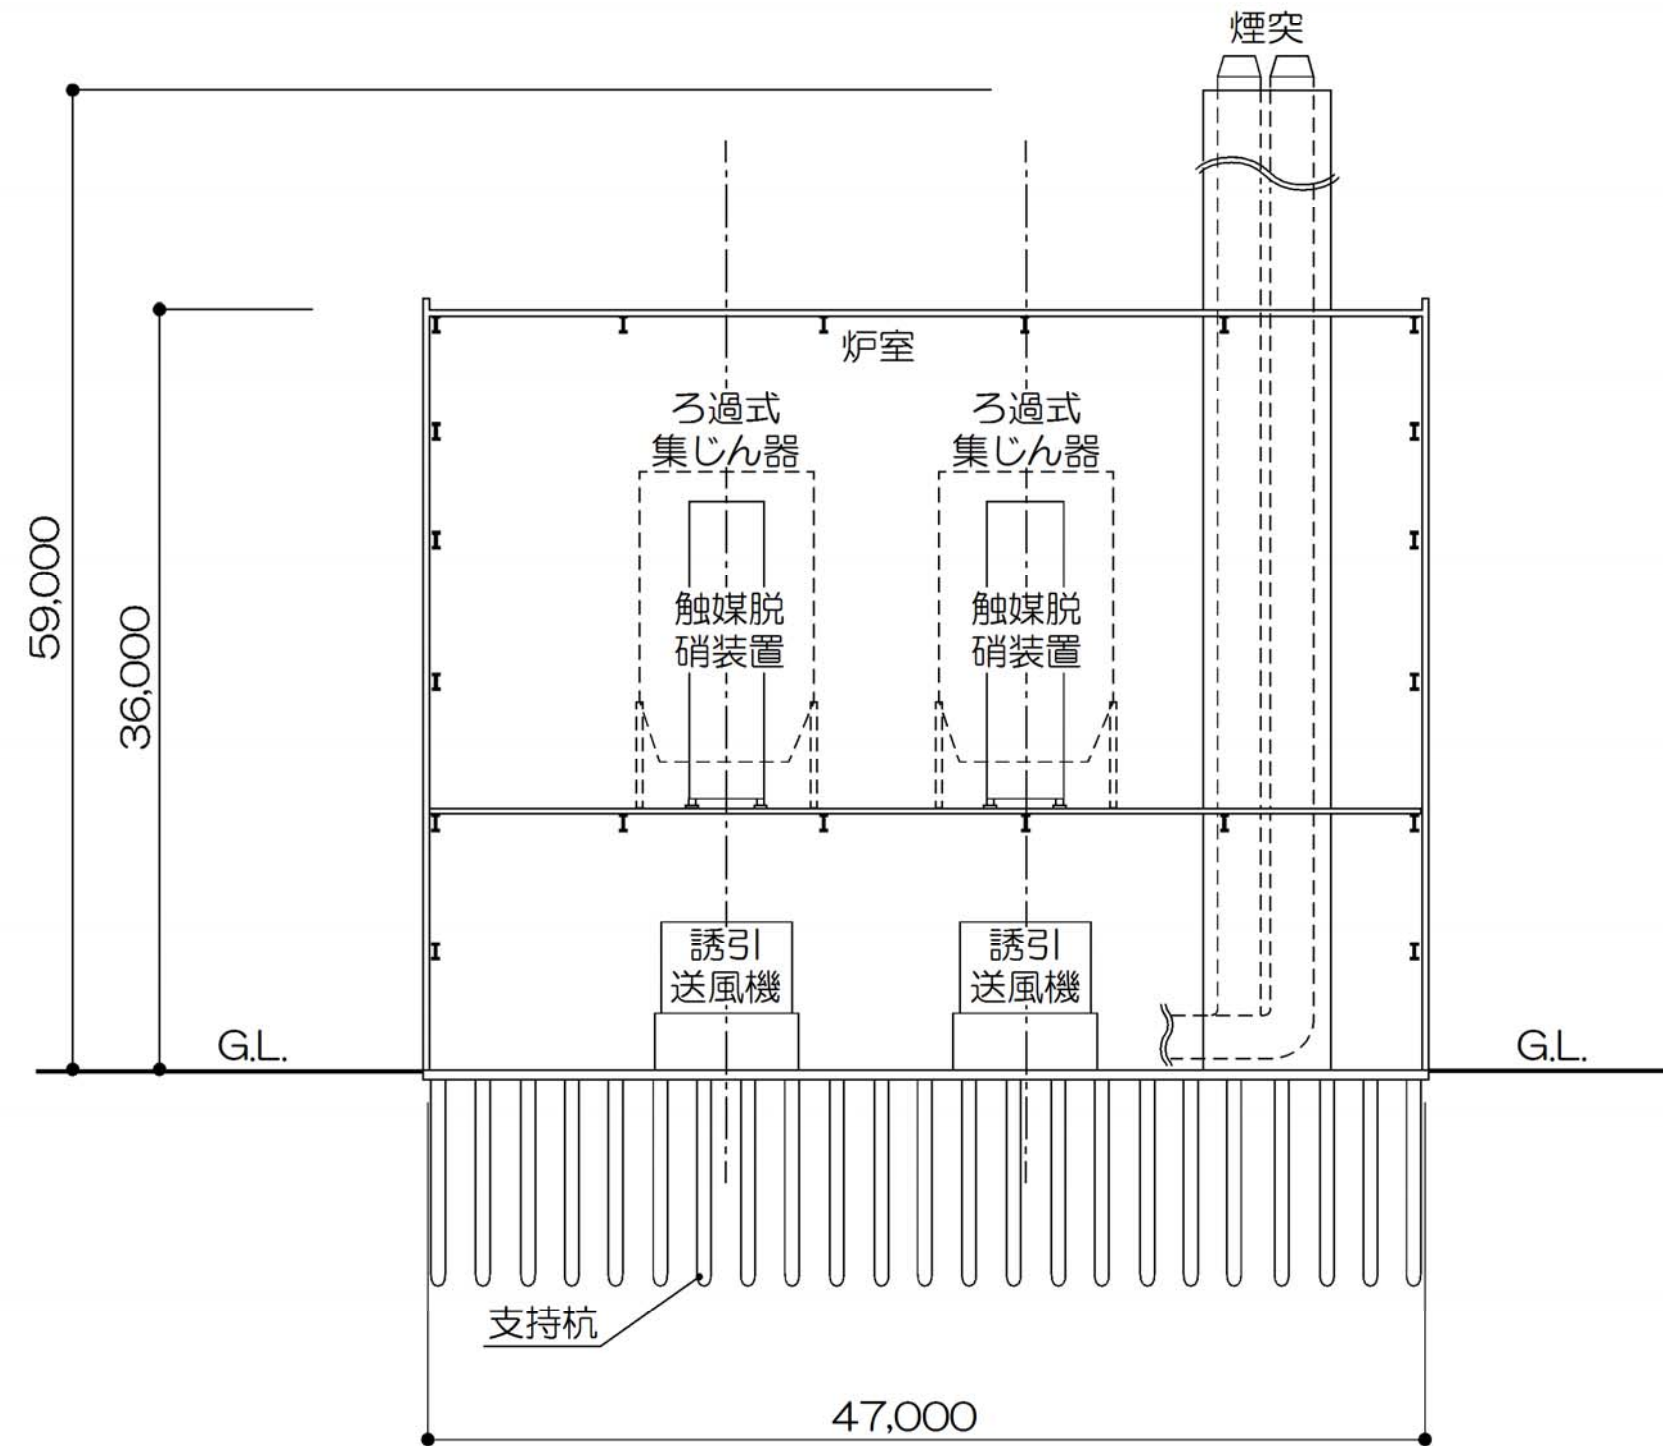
機器配置標準断面図 B-B' (本施設)
